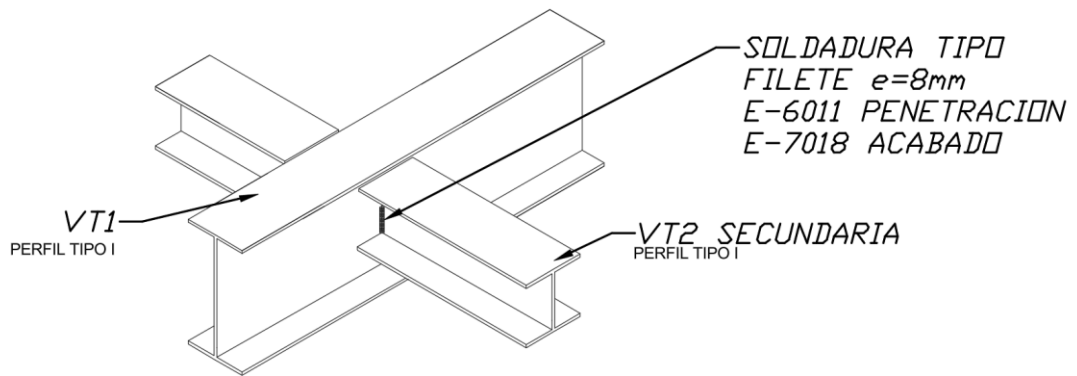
Ejemplo de detalle de soldadura en vigas secundarias.
